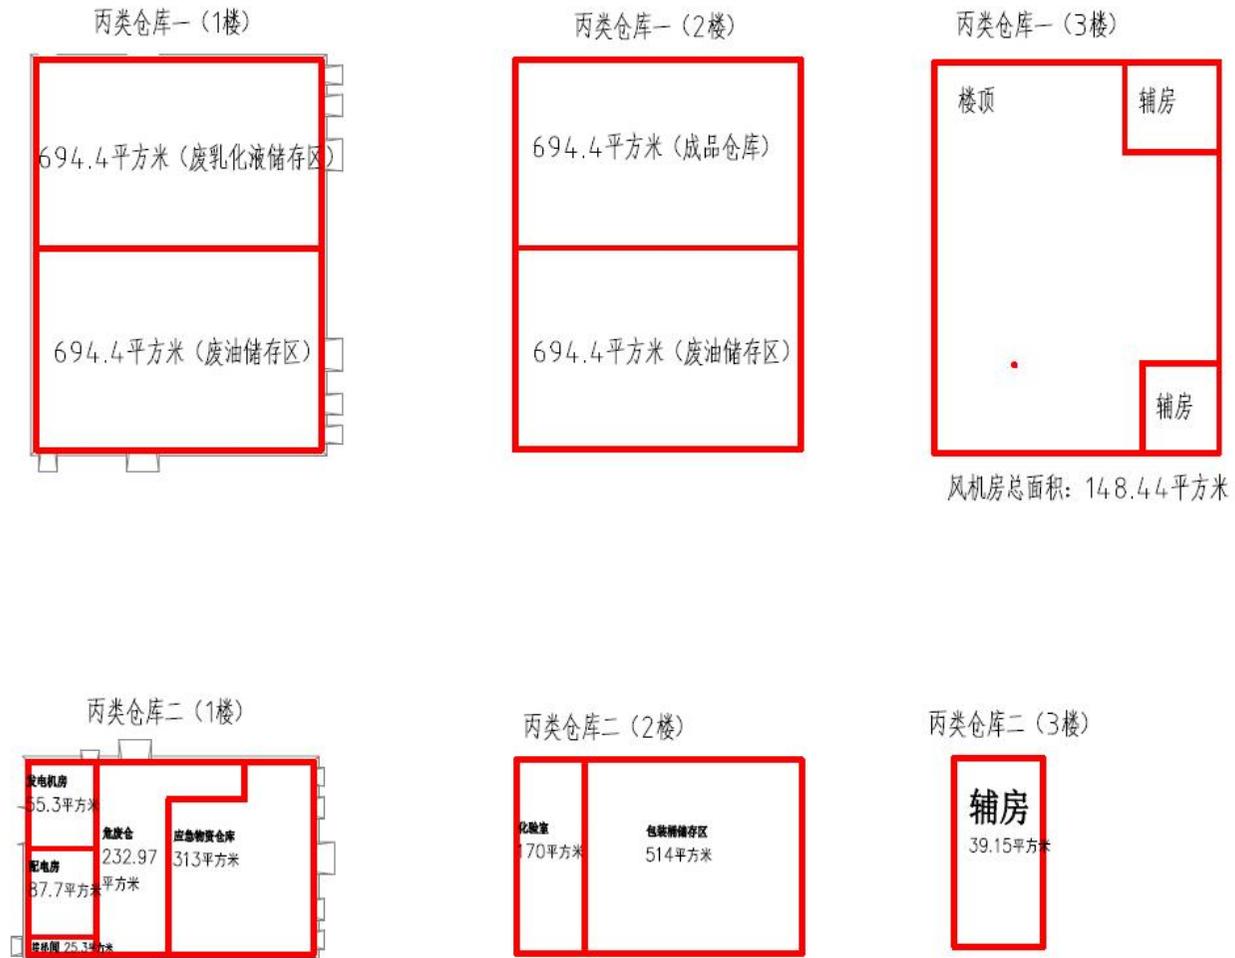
丙类仓库一、仓库二平面布置图
